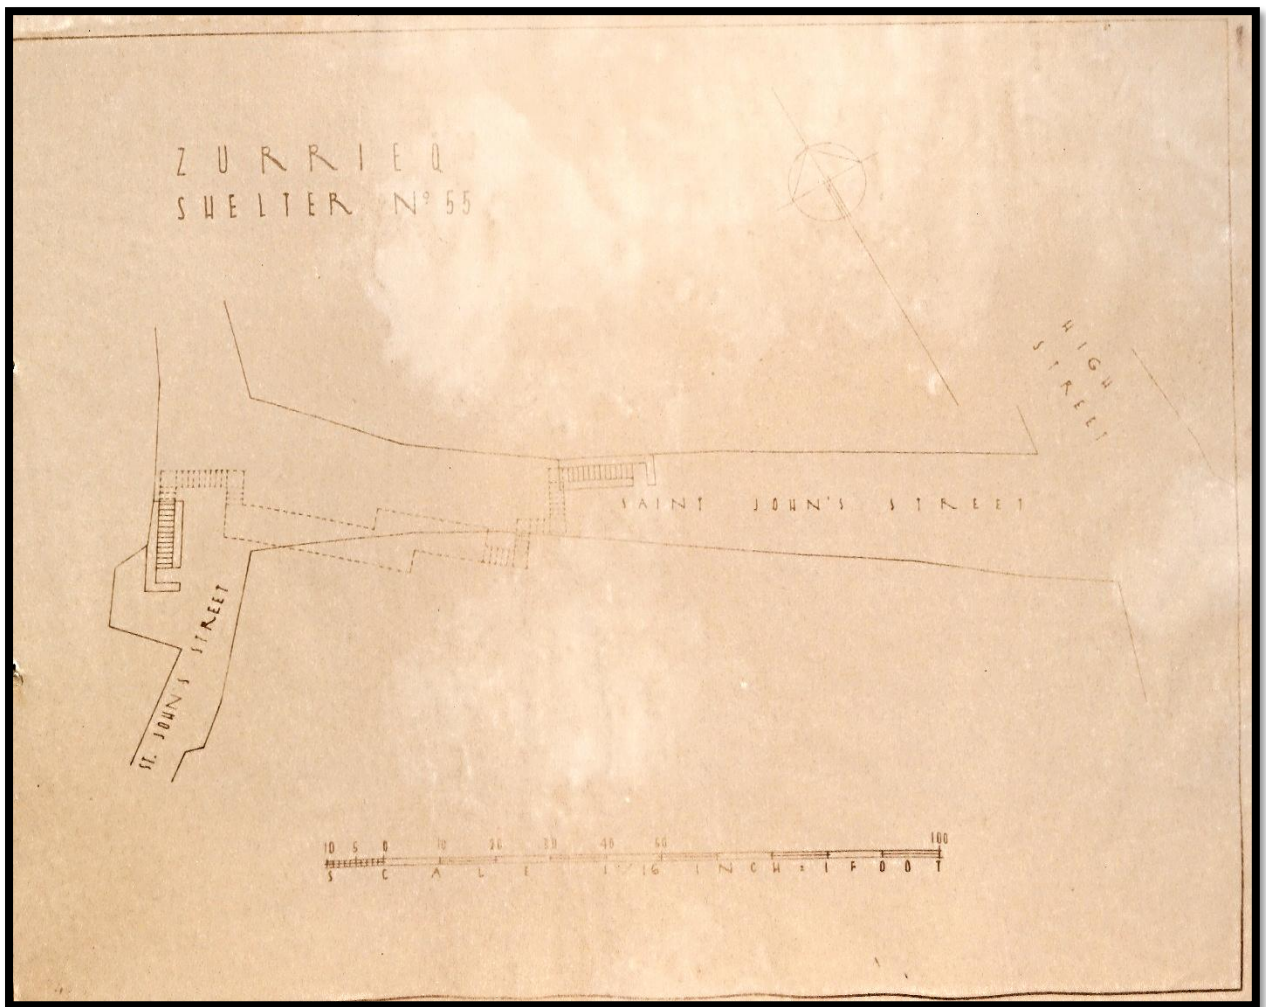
Planta do Abrigo nº55 "St. John Street – Saint John's Street* – High Street."
